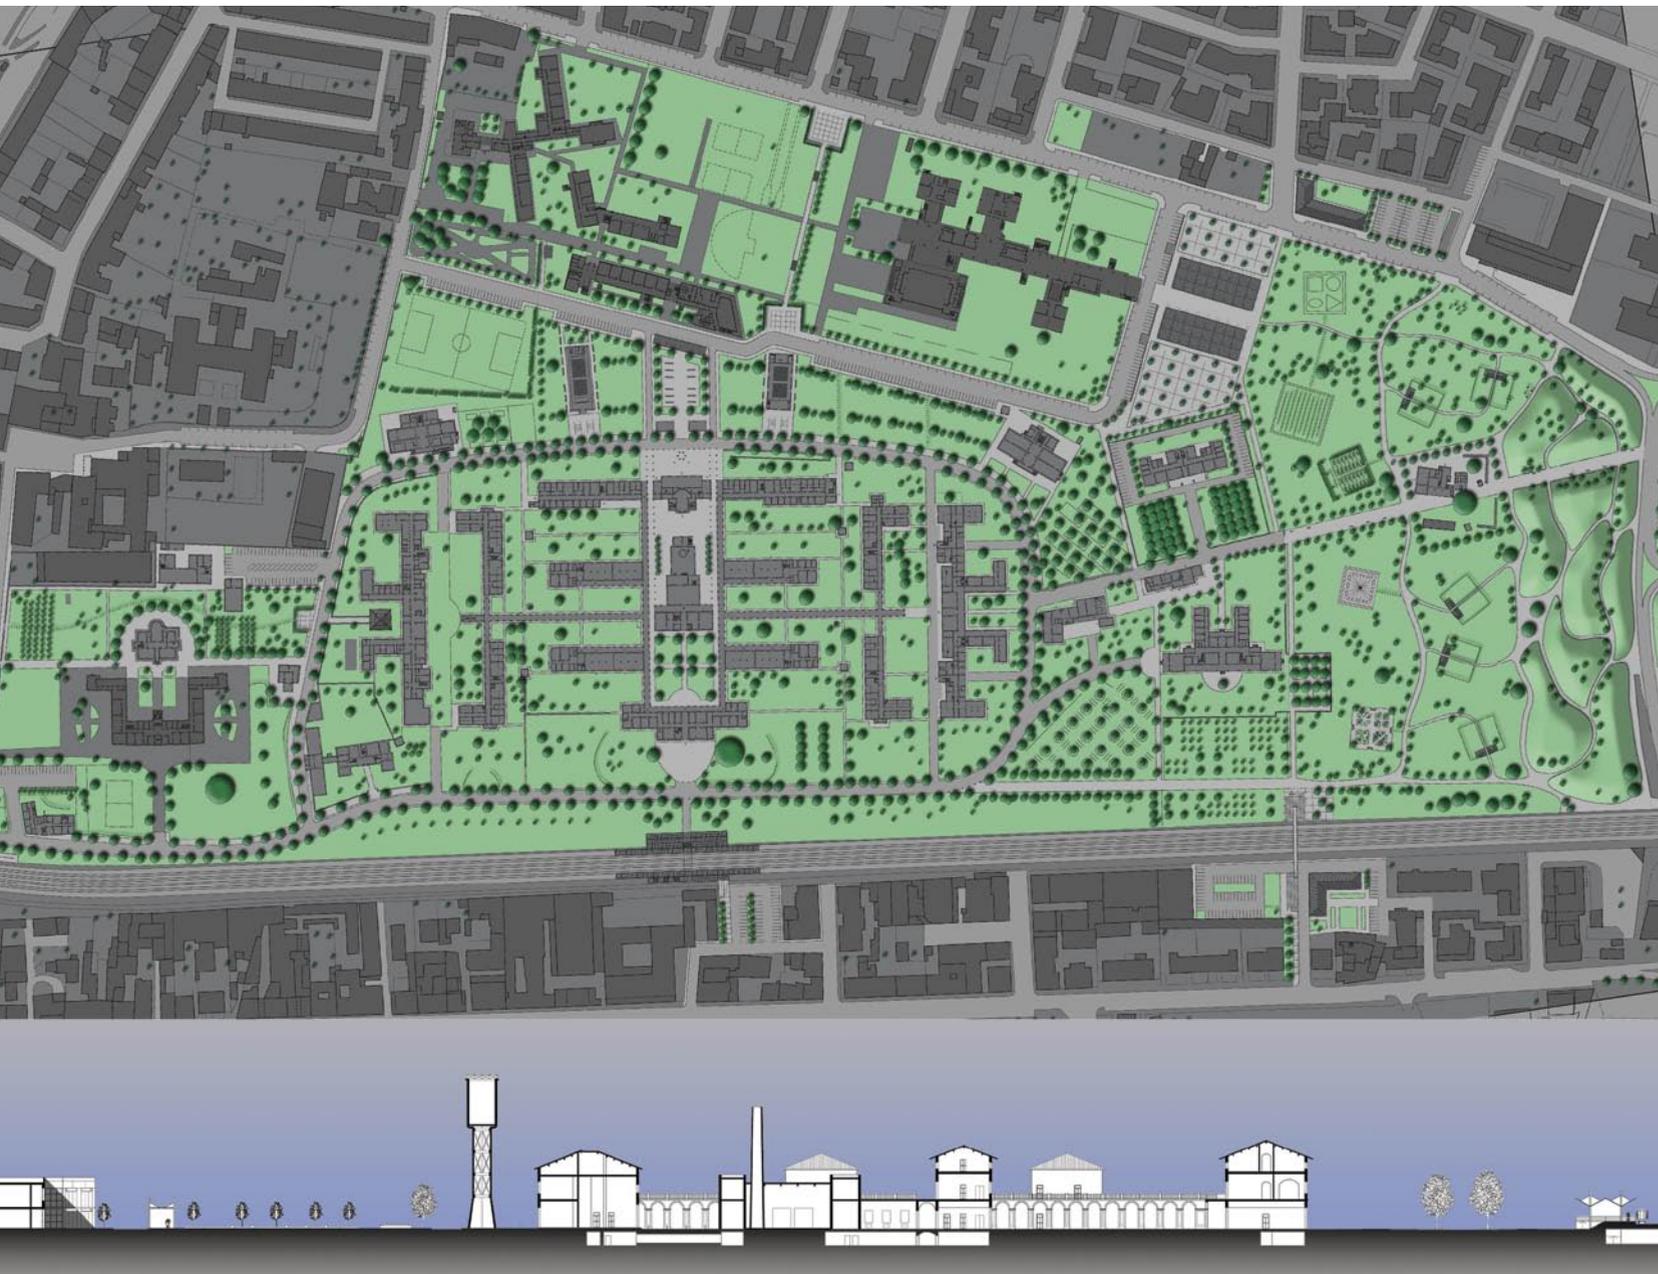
Planimetria generale di progetto. Sezione lungo l'asse dei servizi (N-S).
